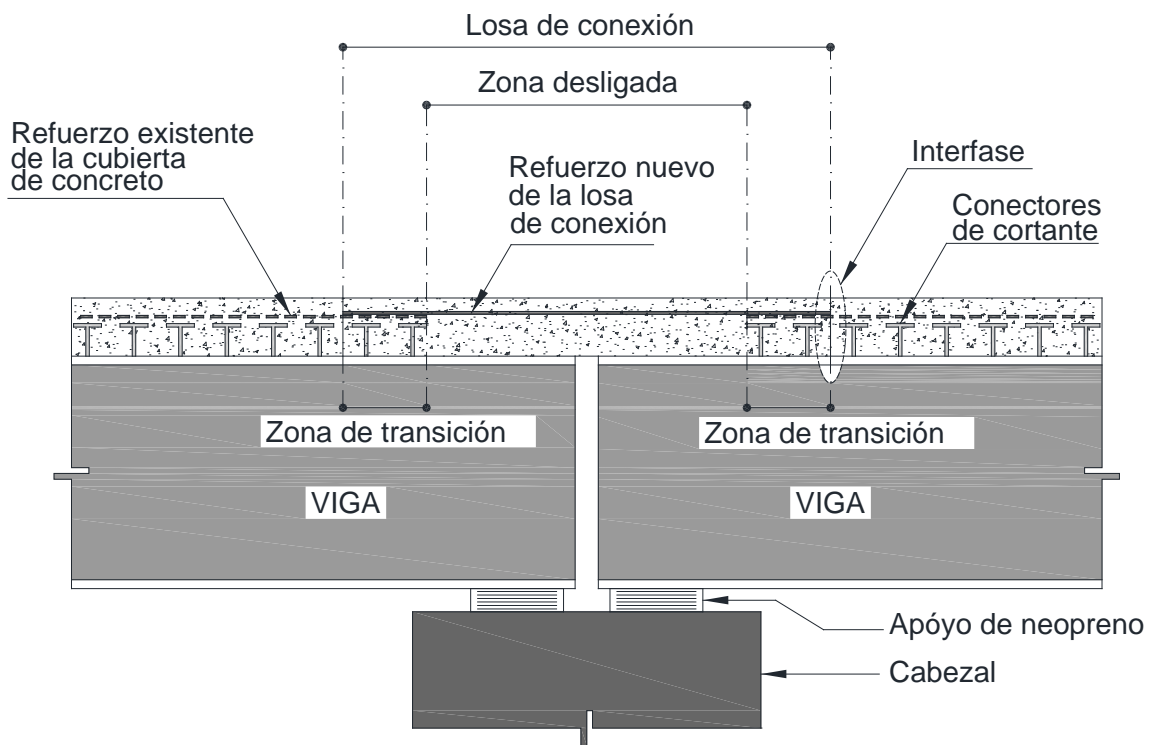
Losa de conexión flexible de concreto reforzado. Se observa una zona desligada de la losa en los extremos de las trabes. En el caso de vigas de acero se utilizan conectores de cortante para ligar la losa a las trabes y en caso de vigas de concreto la liga se realiza pasando los estribos de las trabes a losa de cubierta.
